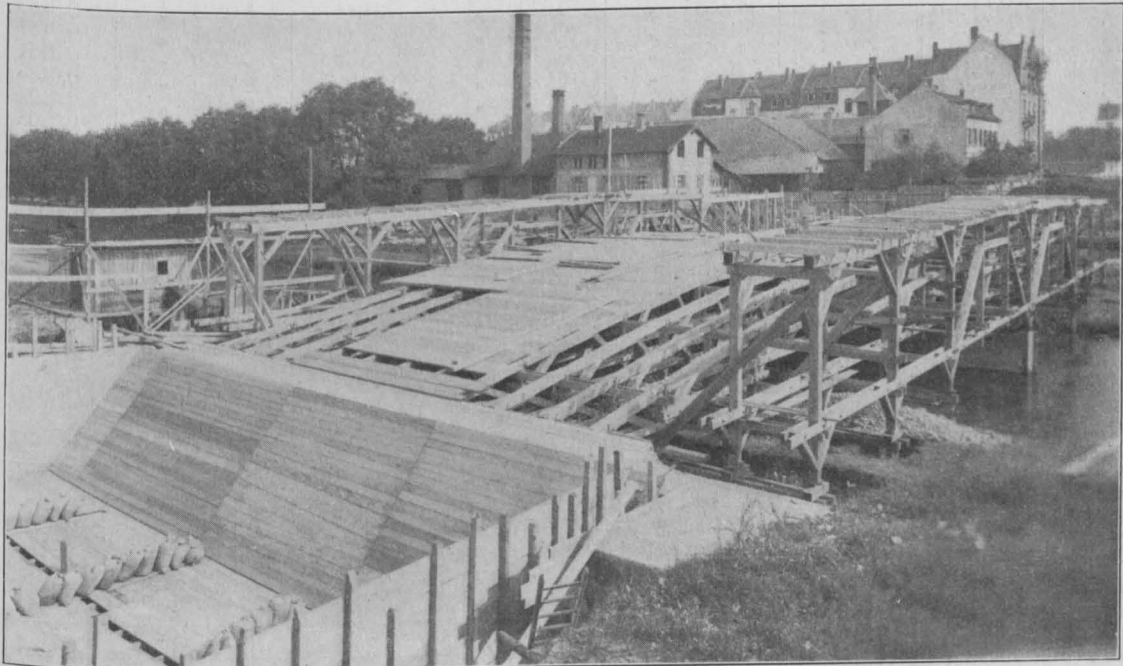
und 27. Lehrgerüst und Einschalung der Eschholz-Straßenbrücke in Freiburg i. Br. Interessante, neuartige Brückenbauten in Eisenbeton.
